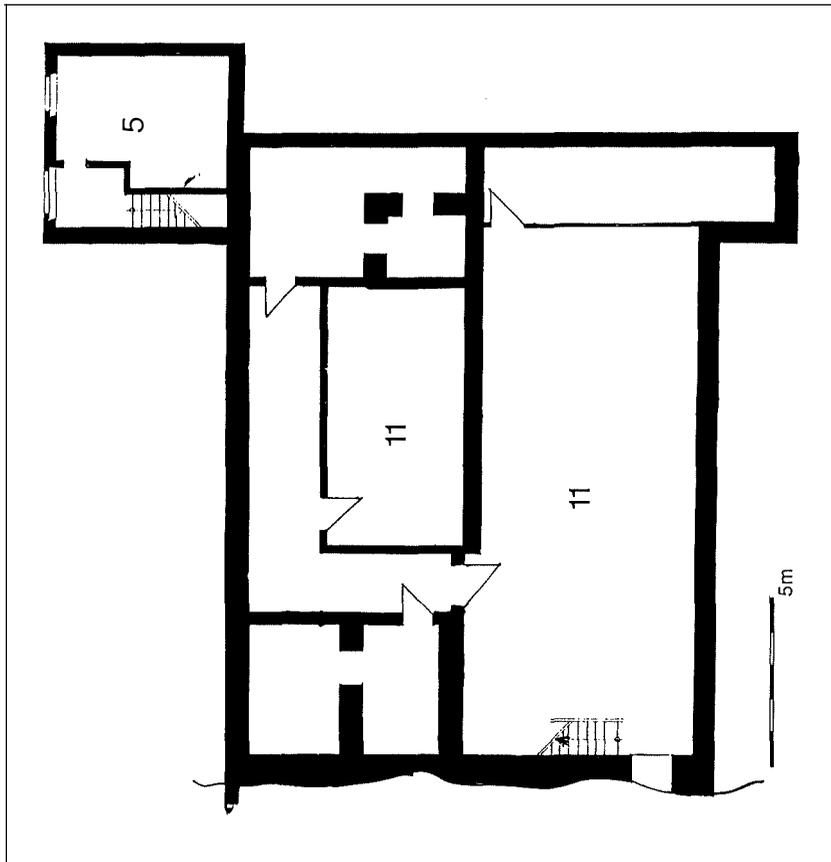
Stadttarchiv Remscheid. Untergeschoß-Grundriß.
